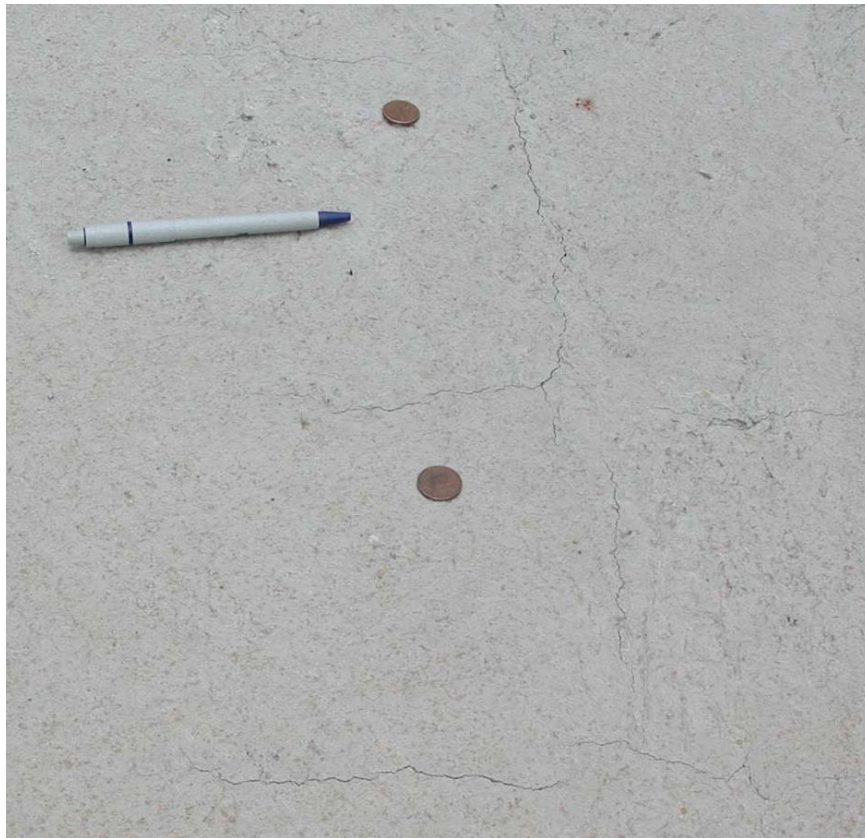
Grietas por Asentamiento Plástico.
